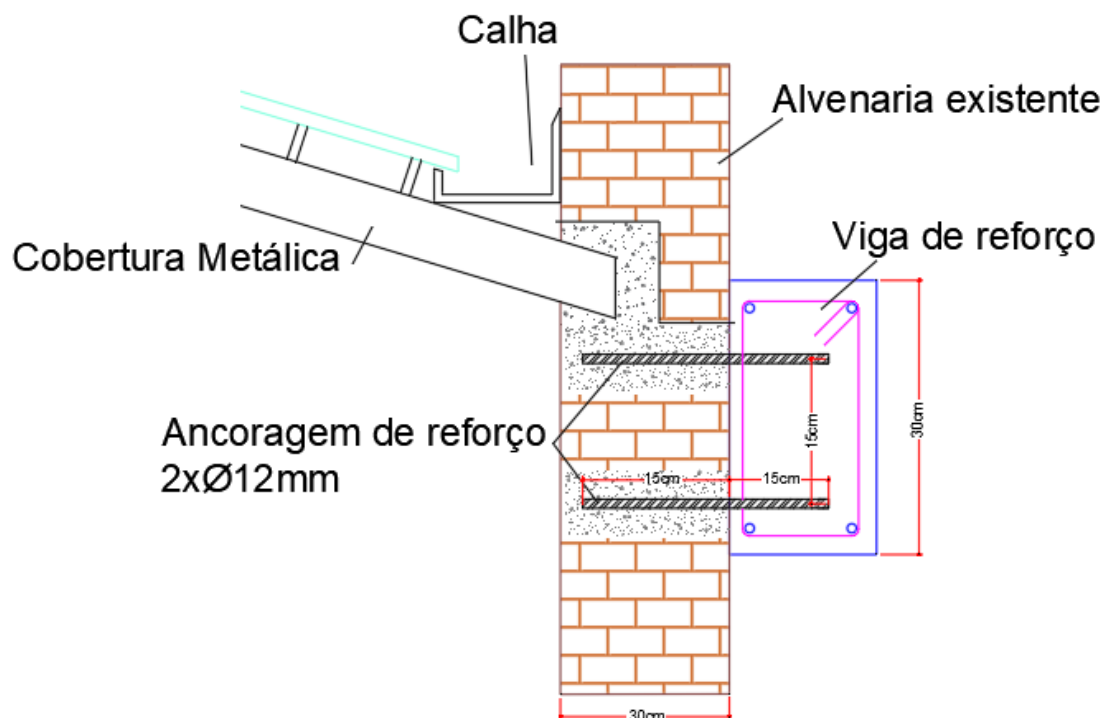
Representação da ancoragem das vigas conforme projeto estrutural.
